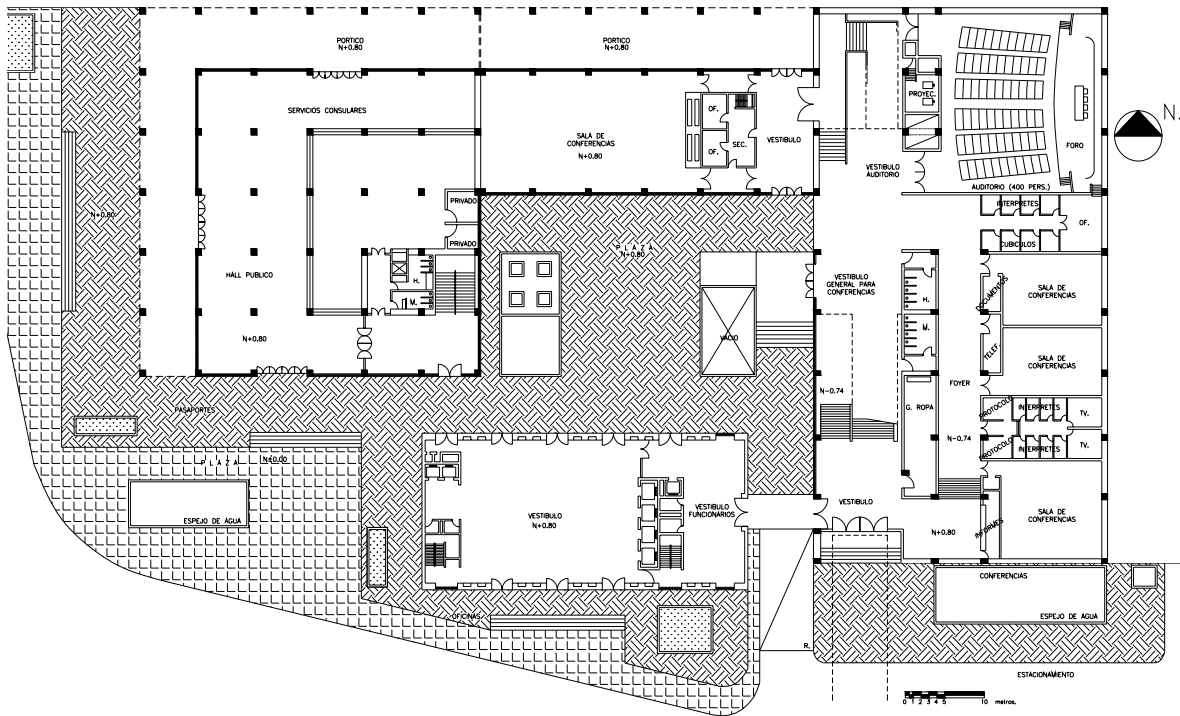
Planta baja (N-0.80m y N+0.70 m)
